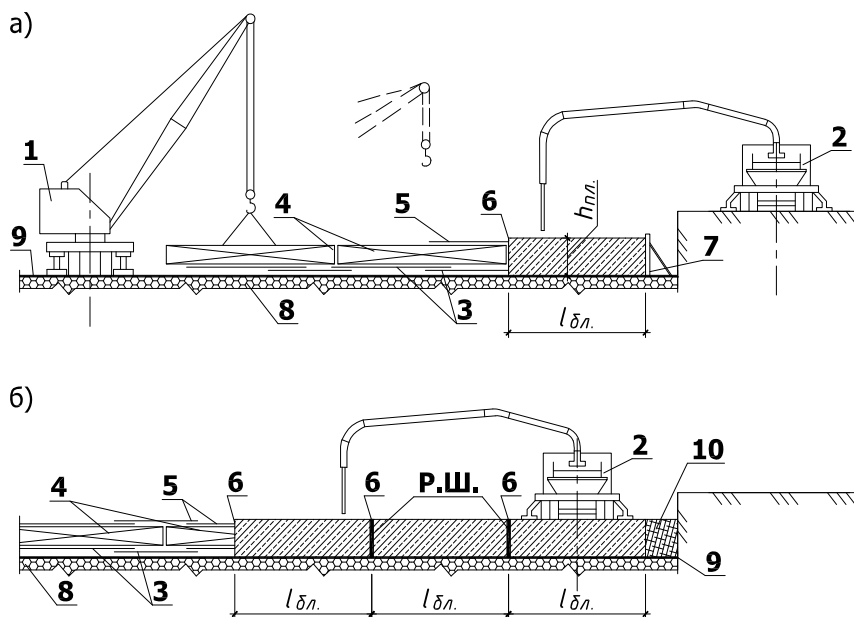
Технологическая схема бетонирования отдельных блоков фундаментной плиты автобетононасосом:
